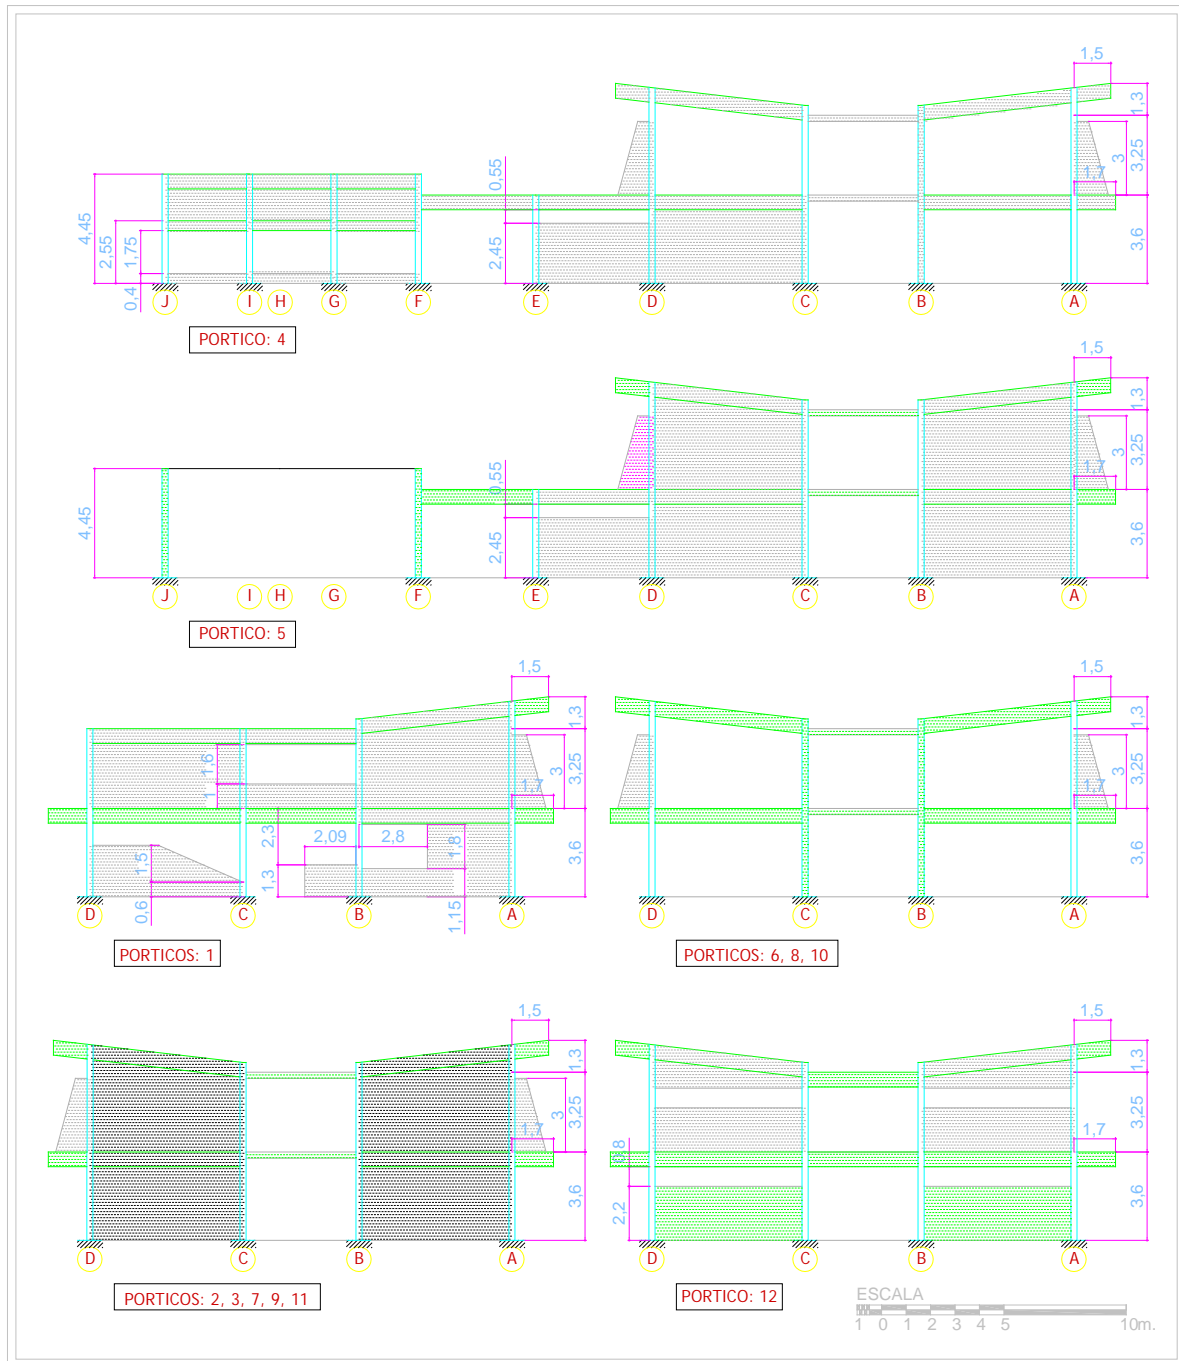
Pórticos transversales (X) del Módulo Principal mostrando las paredes de mampostería y la longitud efectiva de las columnas.
